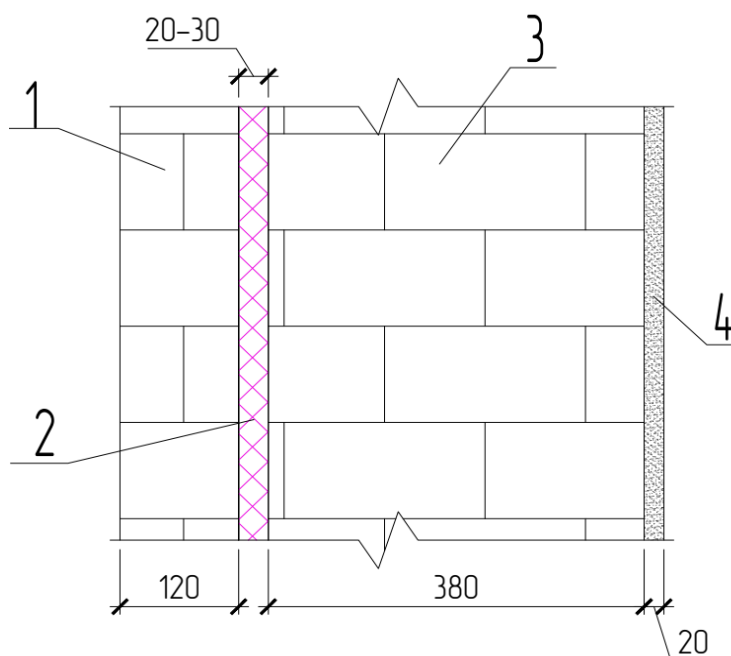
Конструкции стен из кирпичной кладки с вакуумным утеплителем:
